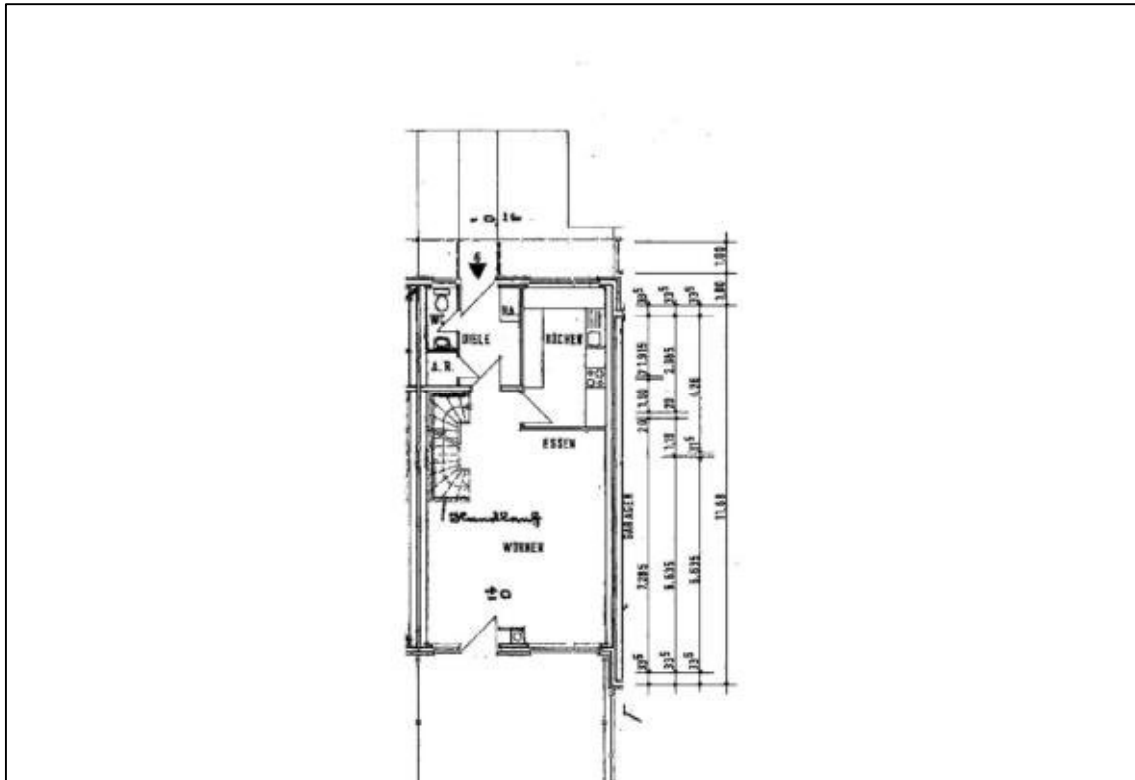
Grundriss vom Erdgeschoss
